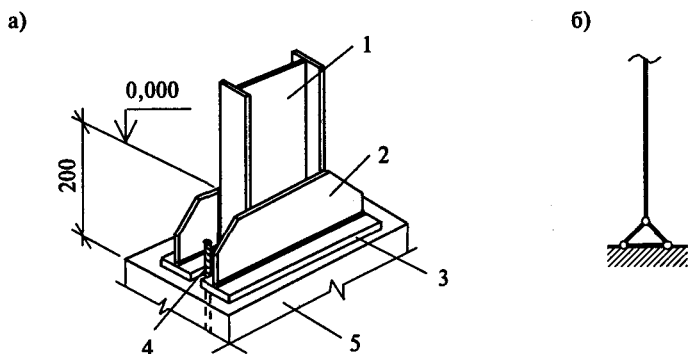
Шарнирное крепление колонны к фундаменту:
